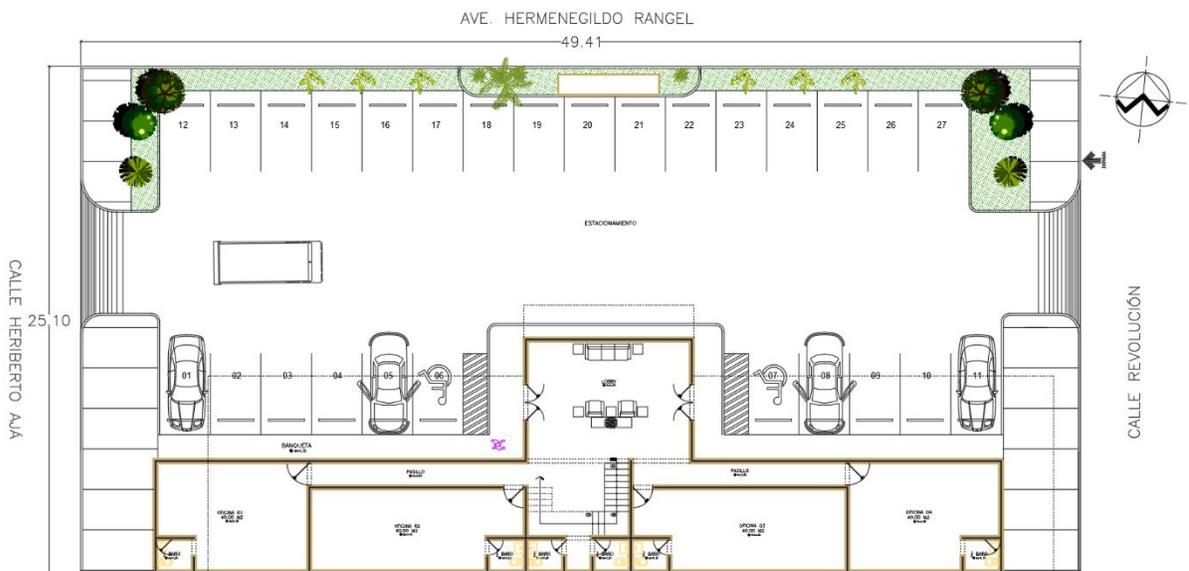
V.17 Planta arquitectónica esquemática de proyecto de oficinas
